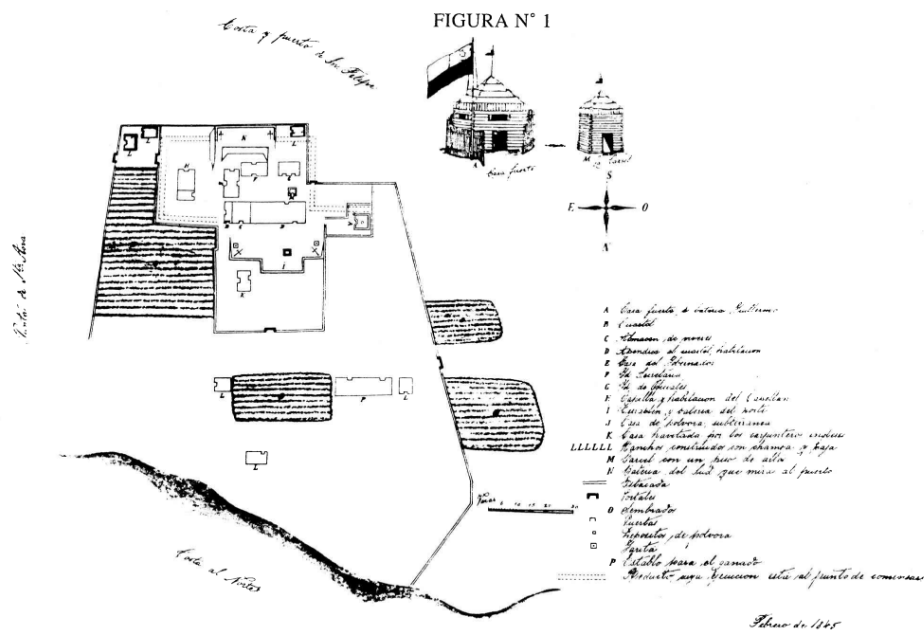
Plano Fuerte Bulnes levantado 1845. Fuente: Matinic, 2000.
